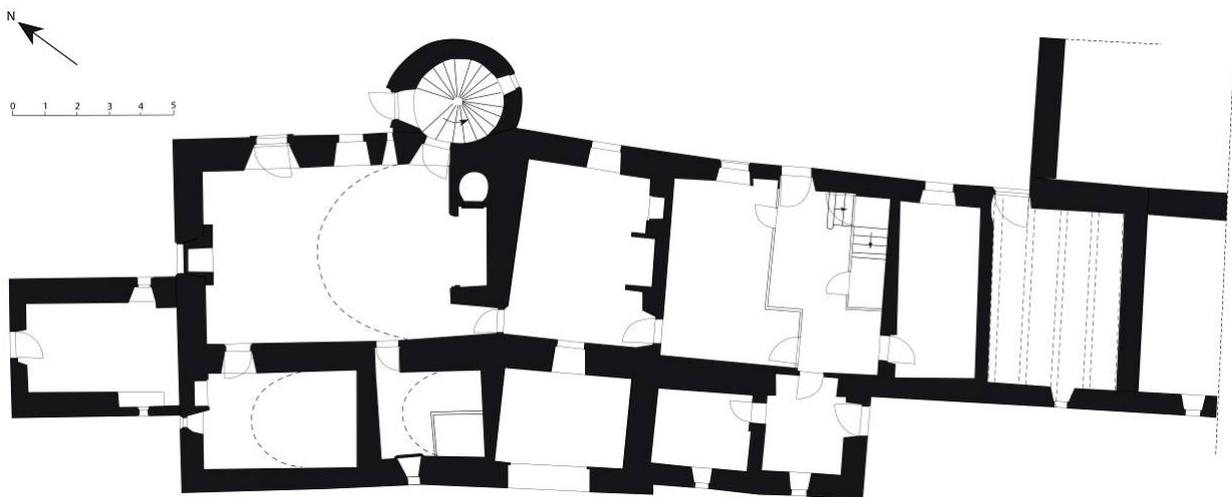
Logis, plan du rez-de-chaussée, état actuel.
